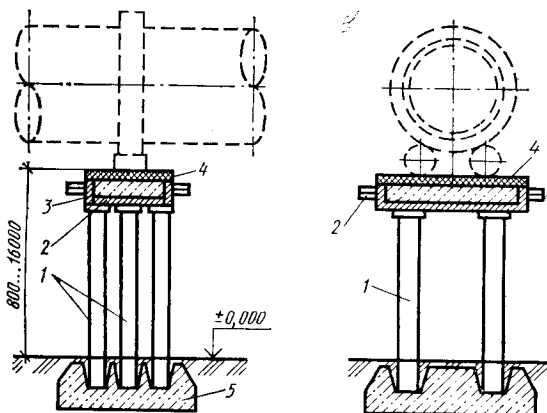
Сборно-монолитный рамный фундамент опор вращающейся плиты:
